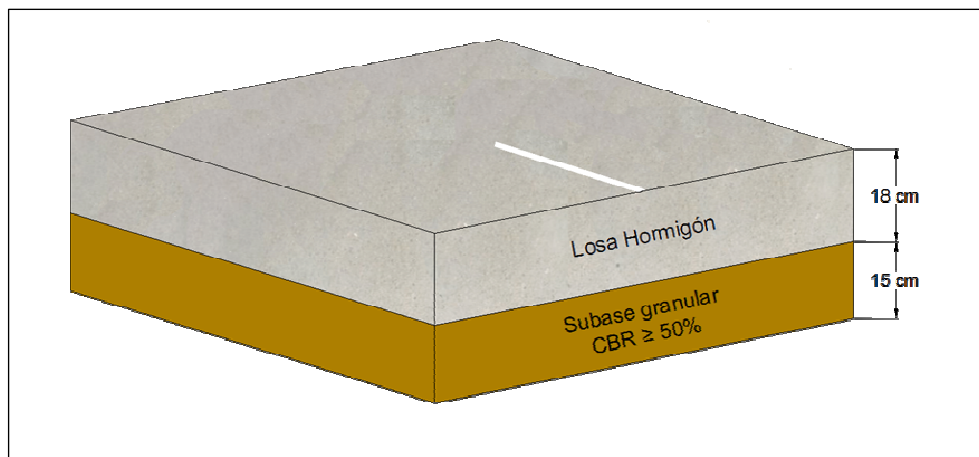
Esquema de la estructura de pavimento de hormigón construida según método AASHTO.
